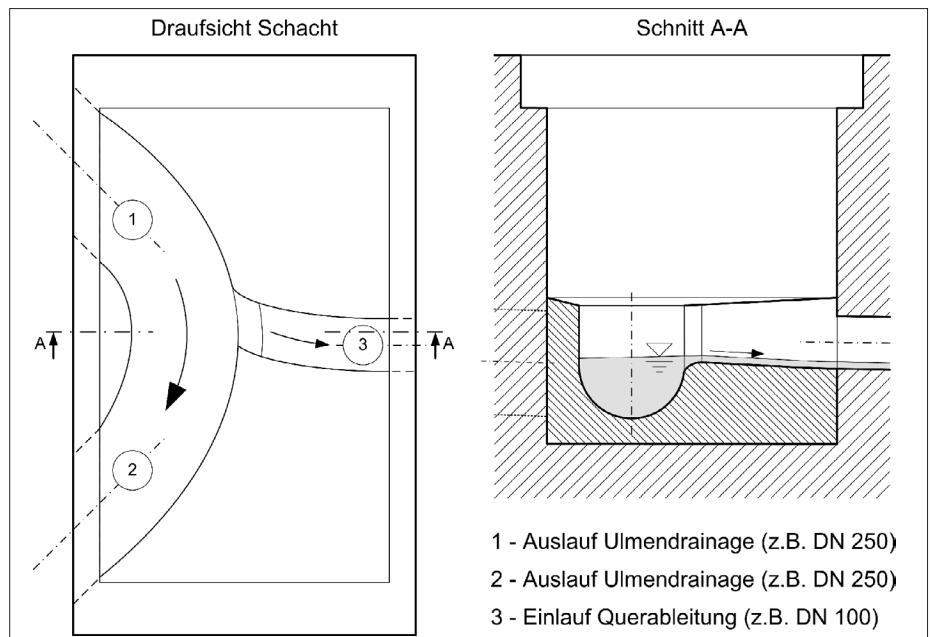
Gerinne zur versinterungsarmen Wasserableitung – Ableitung des Wassers durch die Ulmendrainage, mit Überlaufschwelle zur Regelung einer optimalen Rohrfüllung
